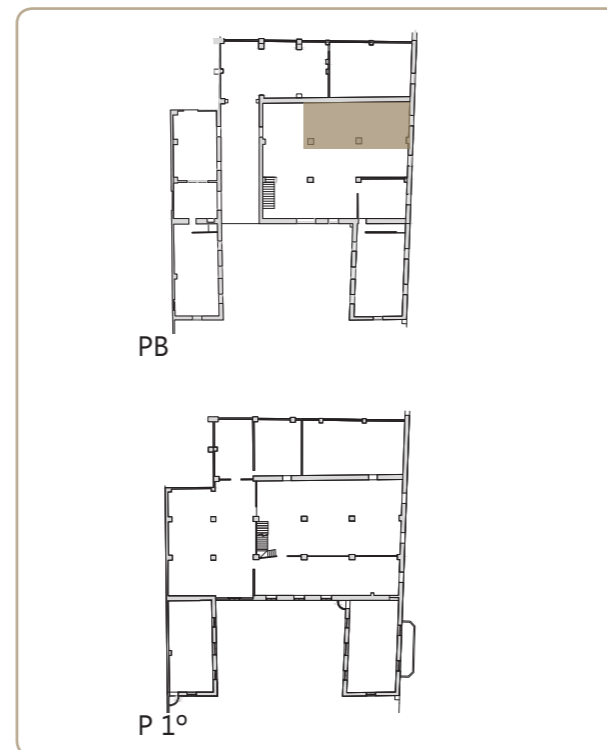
(Izquierda) Esquemas localización pavimento ladrillo macizo.
